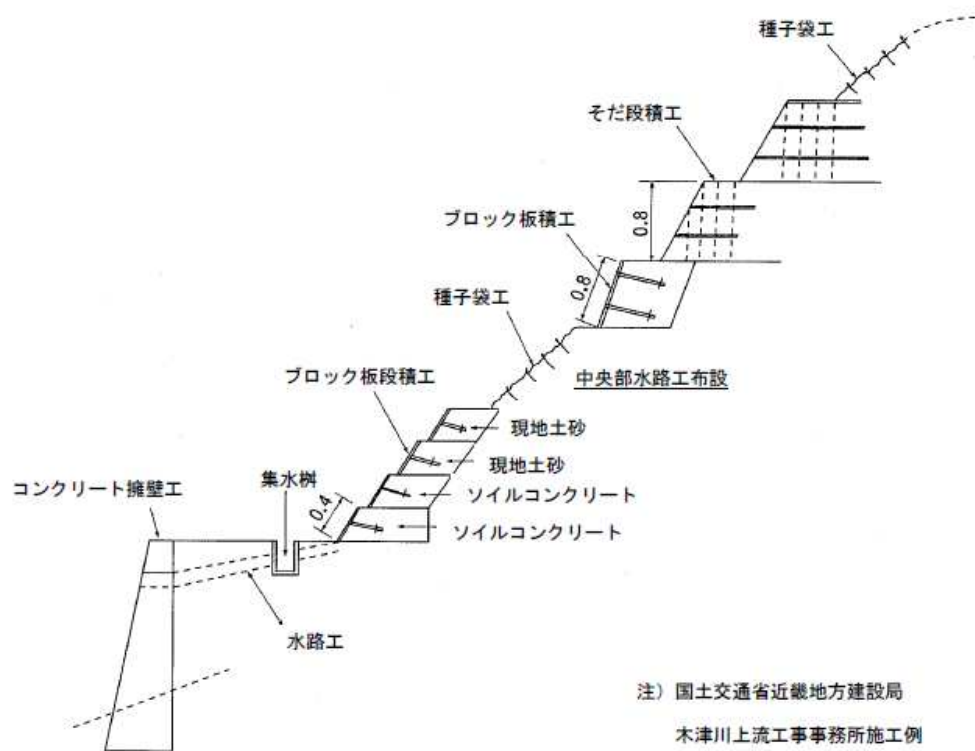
崩壊地（施工例）断面図（単位：m）（再掲）
